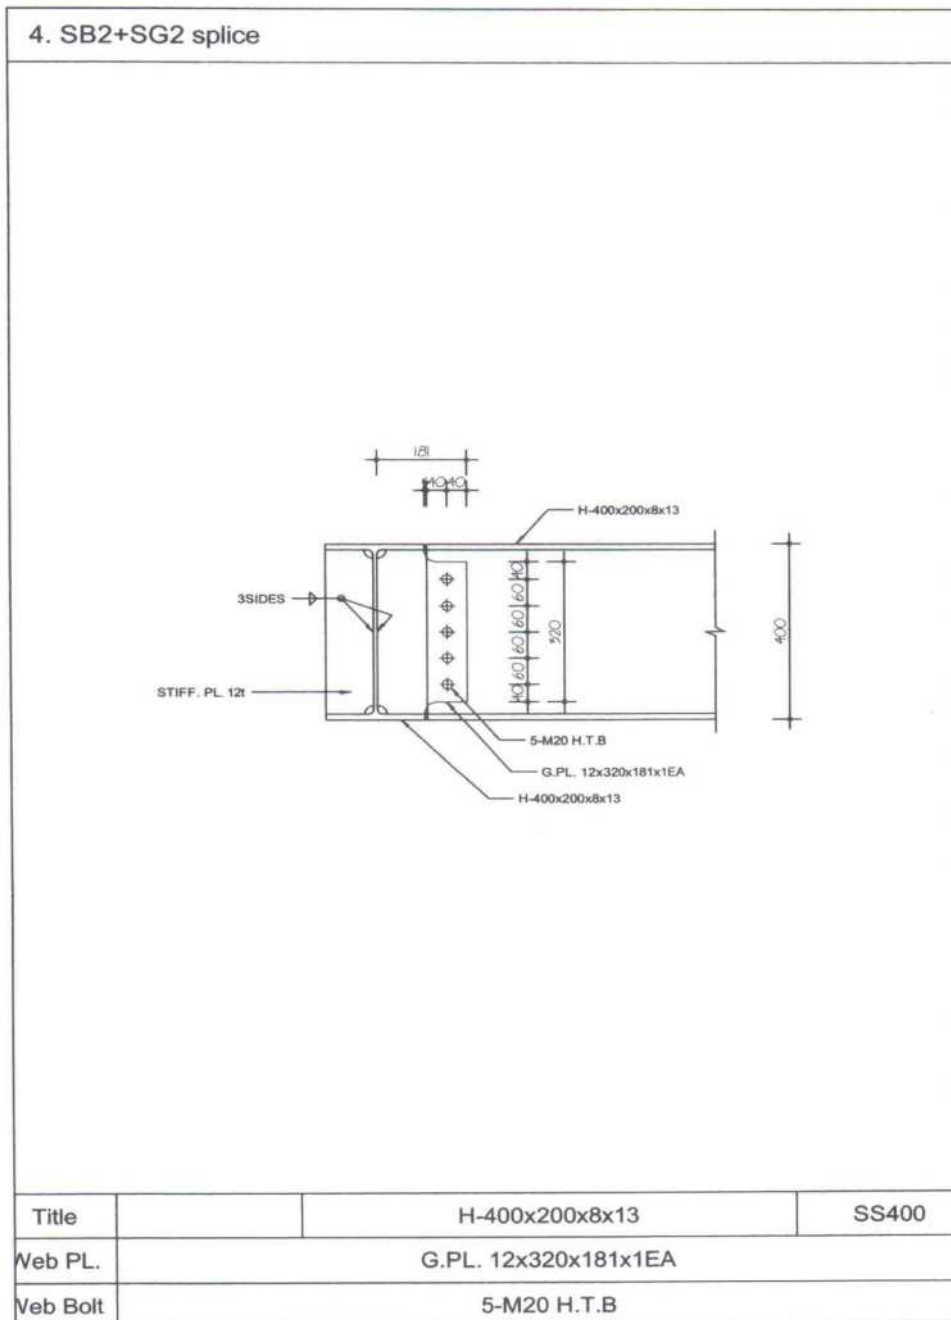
작은보(BEAM)와 큰보(GIRDER)의 접합 상세
